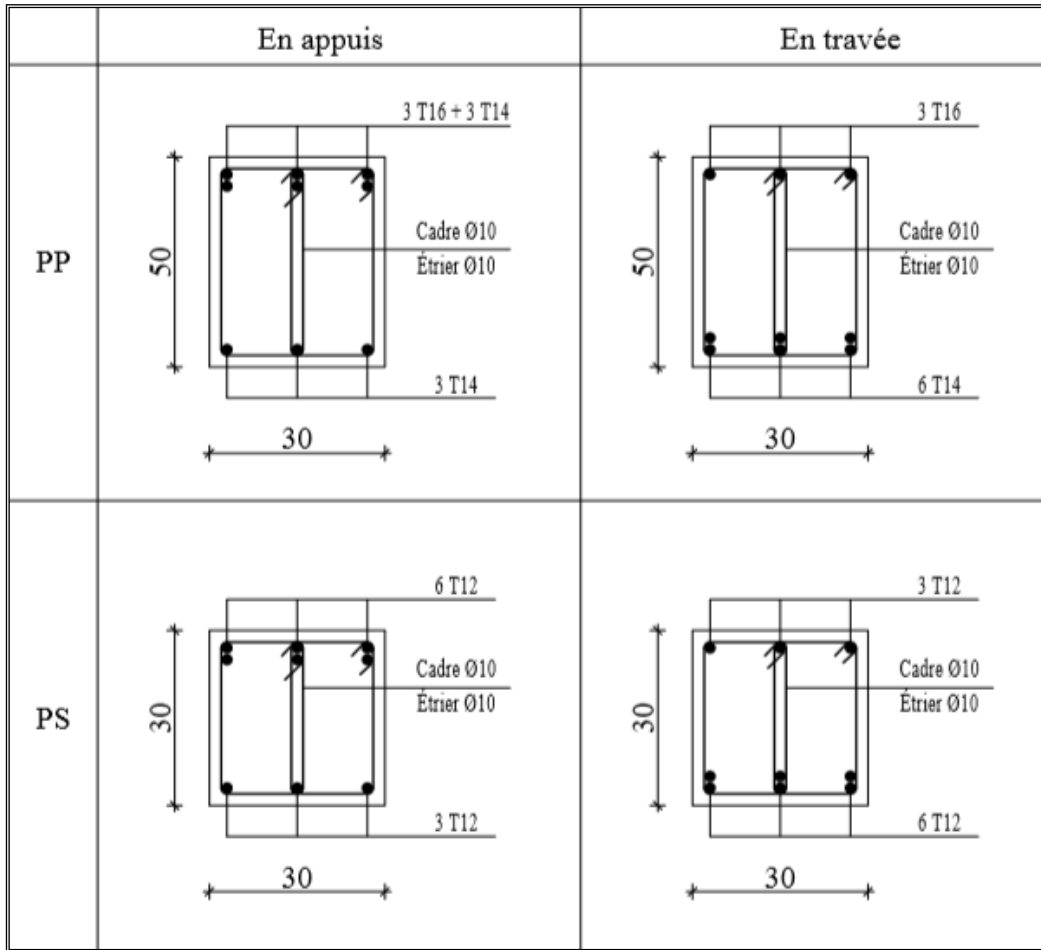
Section de ferrailage des poutres d'étage courant.
